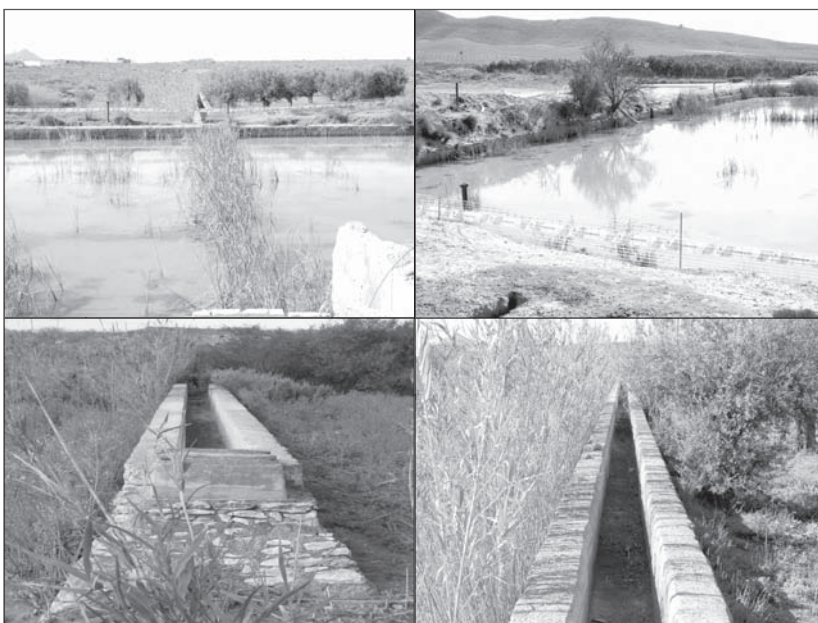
Balsa, canal y sifón de la galería de los Celdranes.
